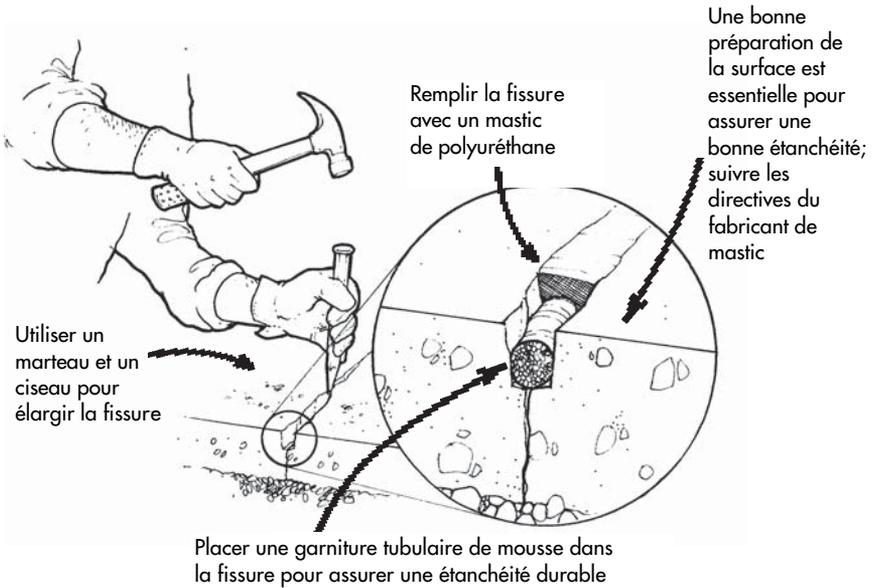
Obturation des fissures dans les murs de fondation et les planchers
